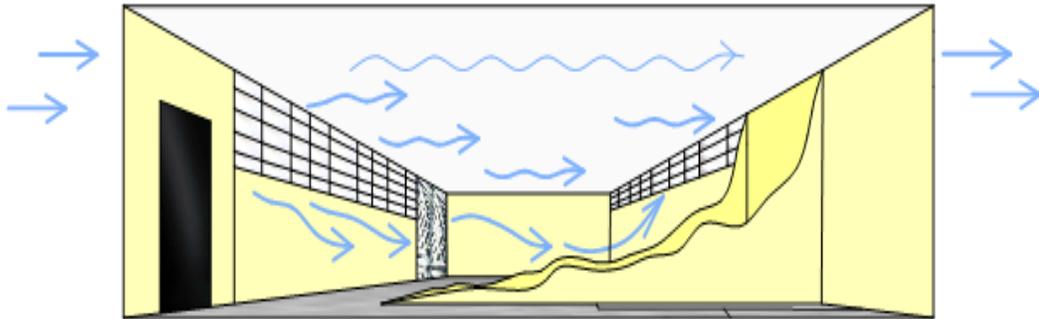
Ventilación con ventanas fijas y de celosilla planta baja (actual)
